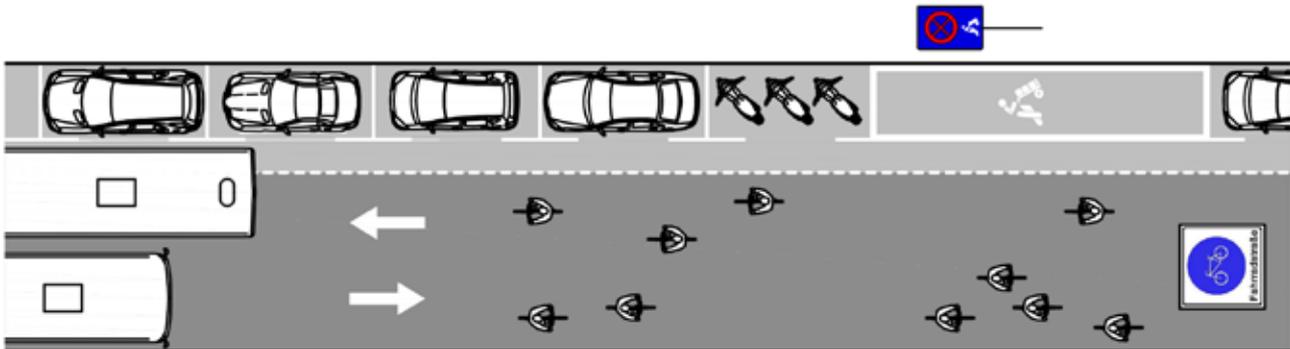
Lageplan, Umgestaltungsvorschlag Holzhausenstraße
